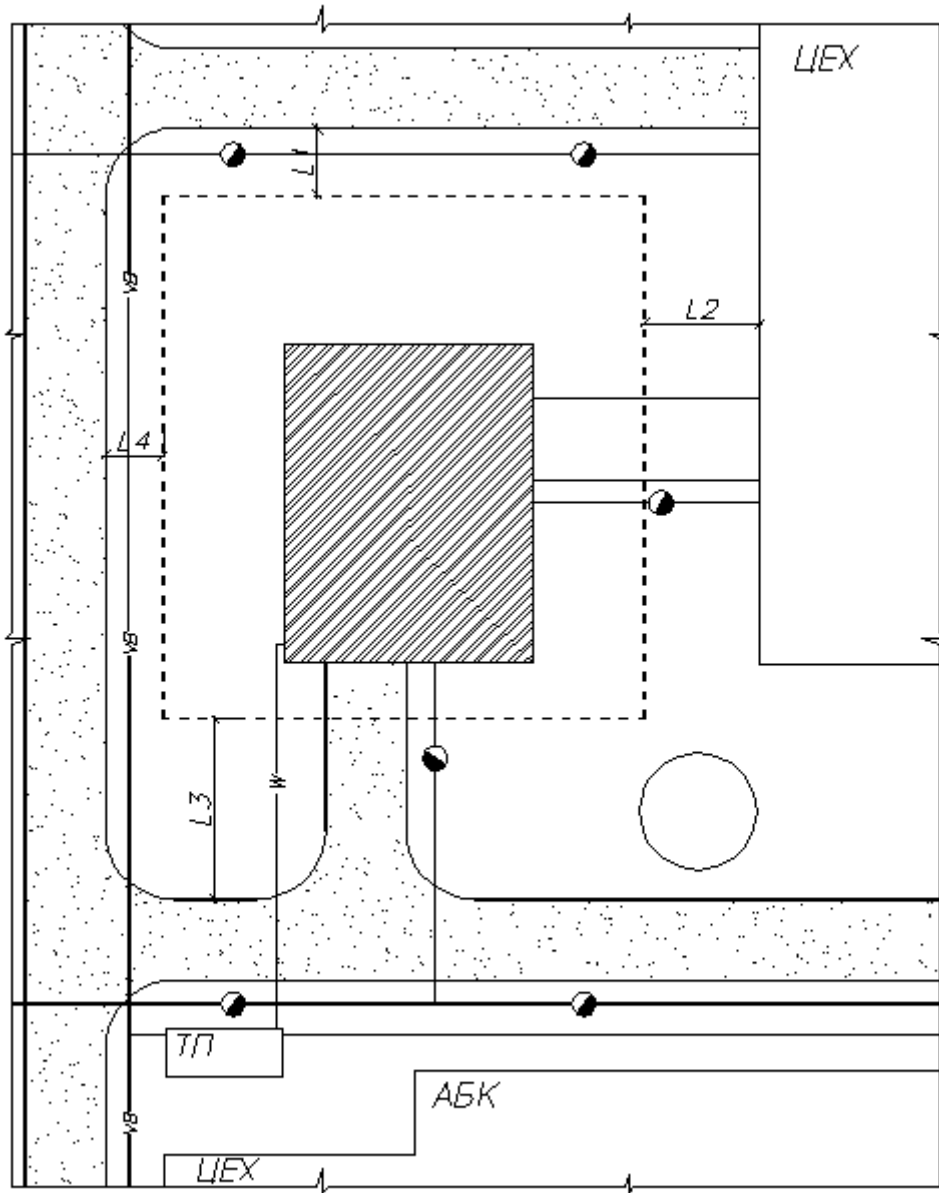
Схема Генплана многоэтажного здания (вариант 1)
